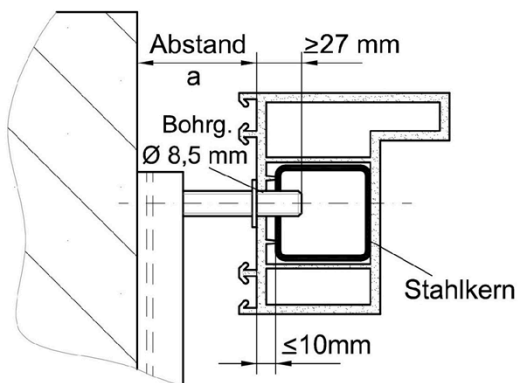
Einbau PVC-Profile mit Stahlkern □ - oder U - Form,  $t \geq 1,5 \text{ mm}$
